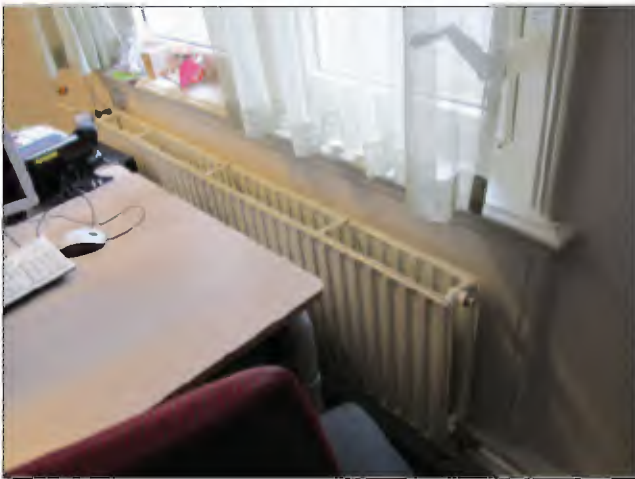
In het bouwdeel uit 1895 zijn enkel plaatselijk lambriseringen gemaakt, namelijk onder de vensters. Deze lambriseringen zijn tegenwoordig niet goed te zien i.v.m. de moderne radiatoren die ervoor geplaatst zijn. Foto genomen in 10.1.b Wob
